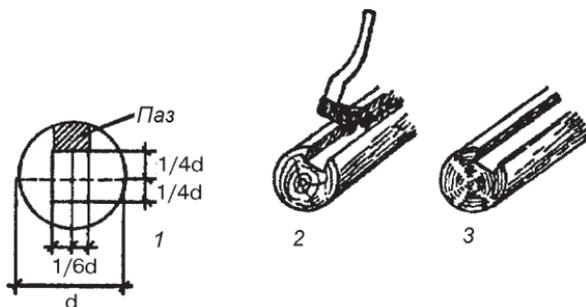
Разметка и выборка прямоугольного паза в бревне
